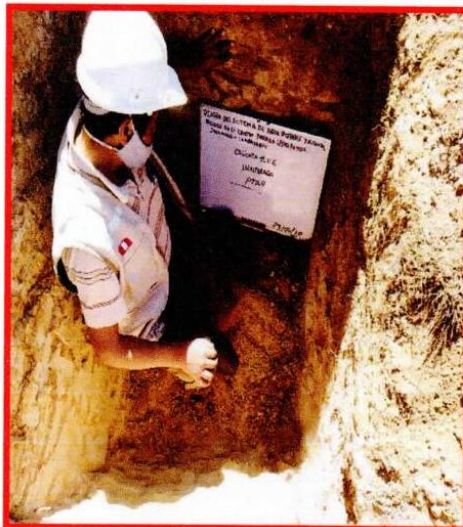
y Foto N° 11. Detalle del perfil del suelo en Calicata C-6.
